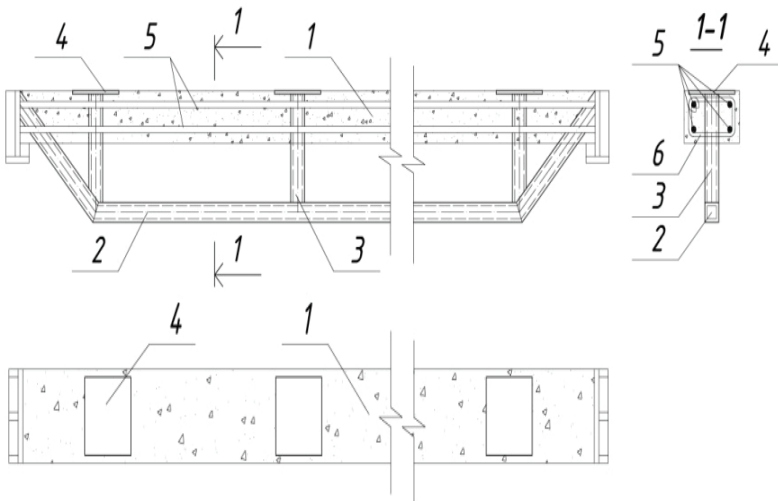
Запропонована балка. 1) залізобетонна лінійна складова; 2,3) труби квадратного профілю; 4) анкери; 5,6) арматурна сітка.
